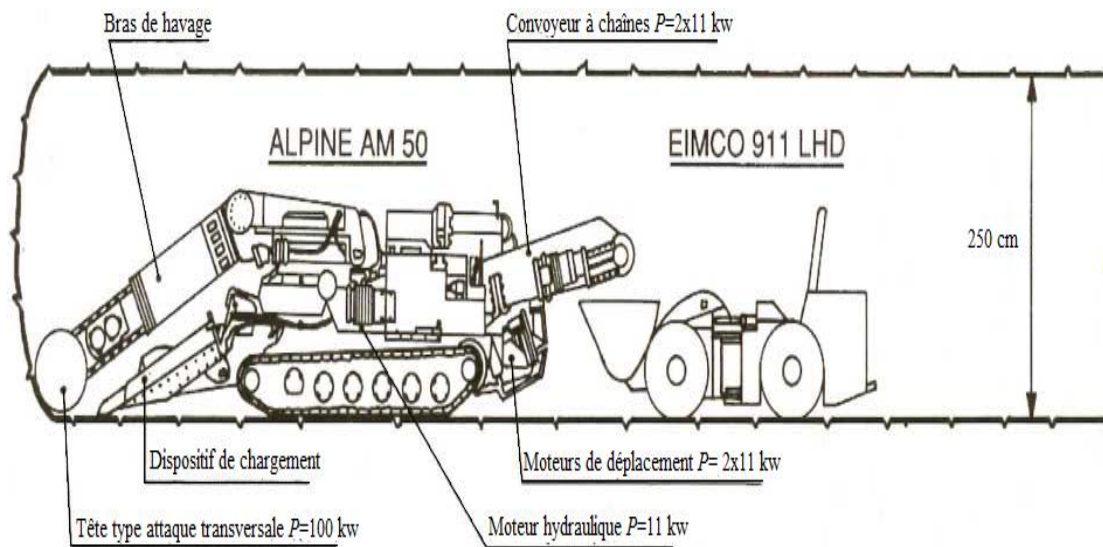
Machine à attaque ponctuelle (Alpine)
